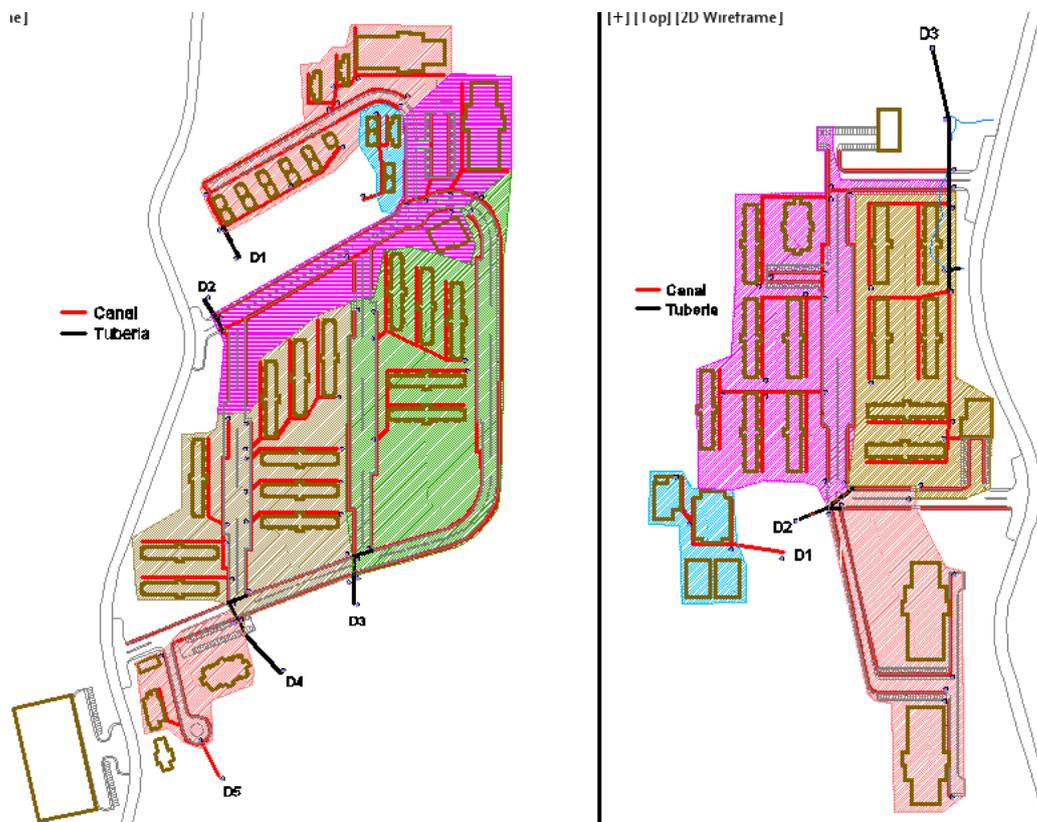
Ubicación de descargas con sus áreas de drenaje del campamento de construcción
